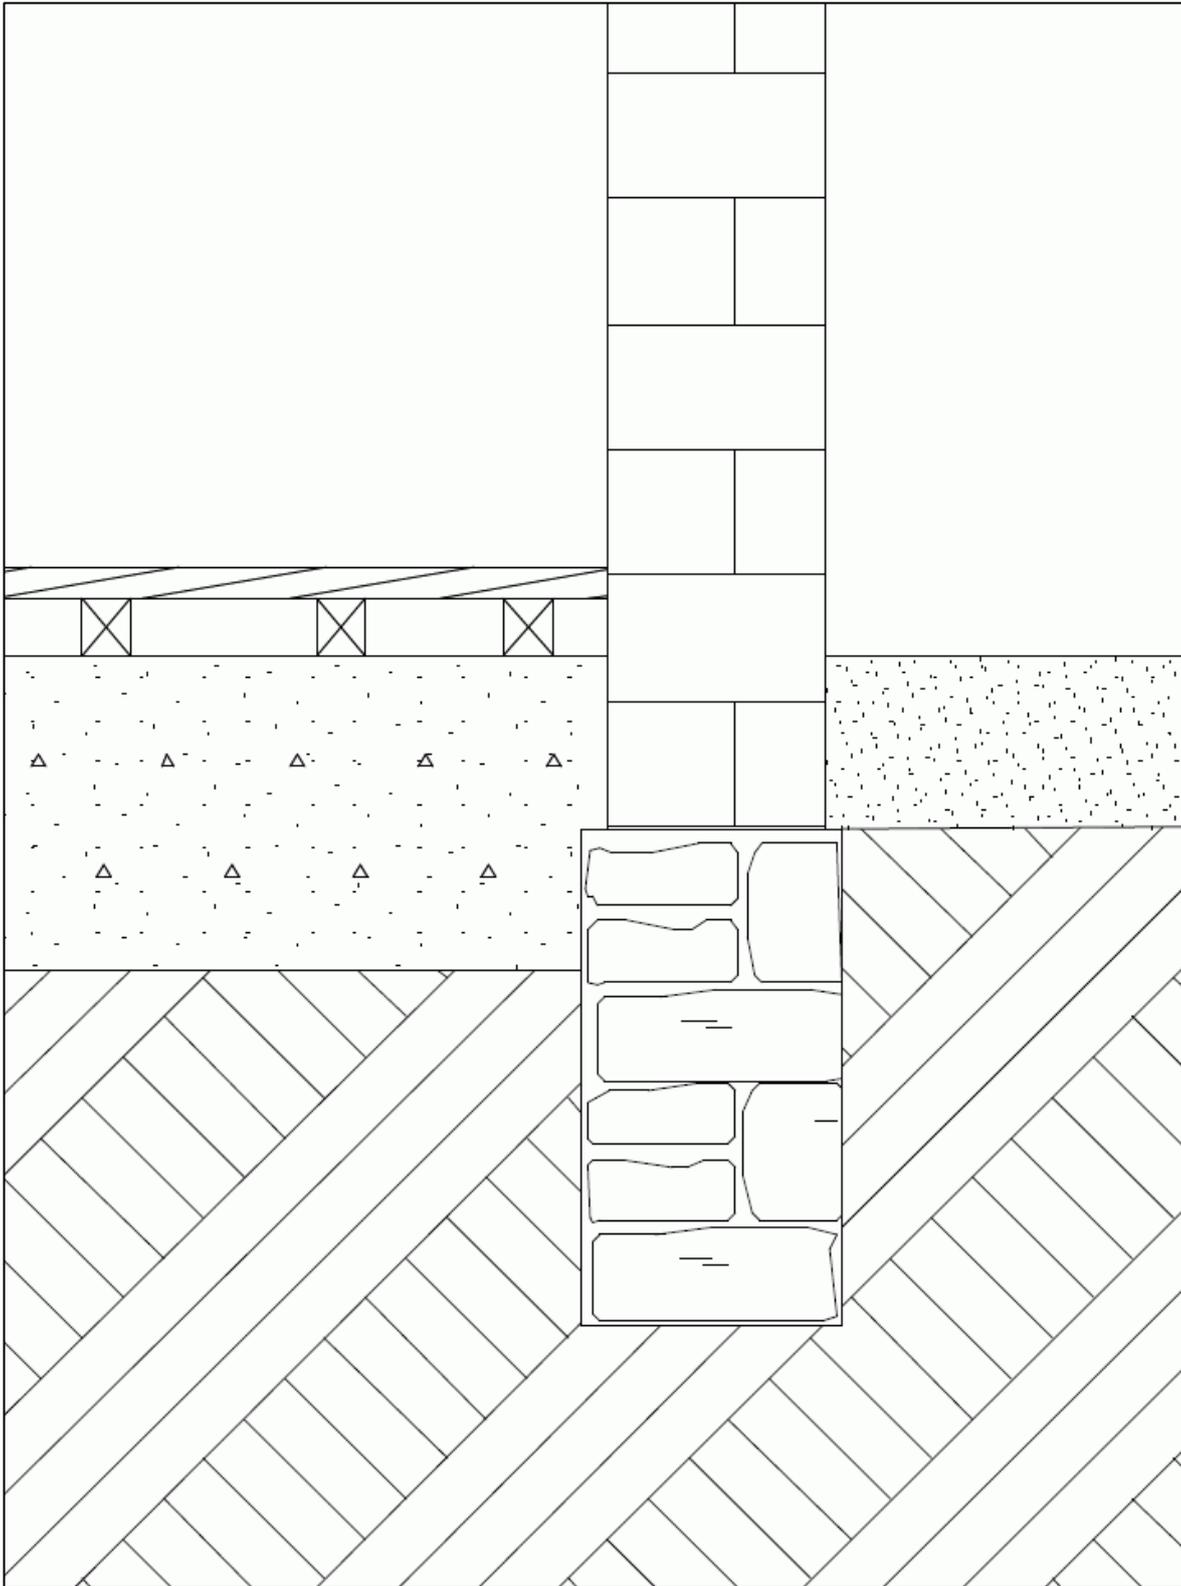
Holzzielung auf Lagerholz, ohne Unterbeton und Abdichtung (Bestandslösung)
